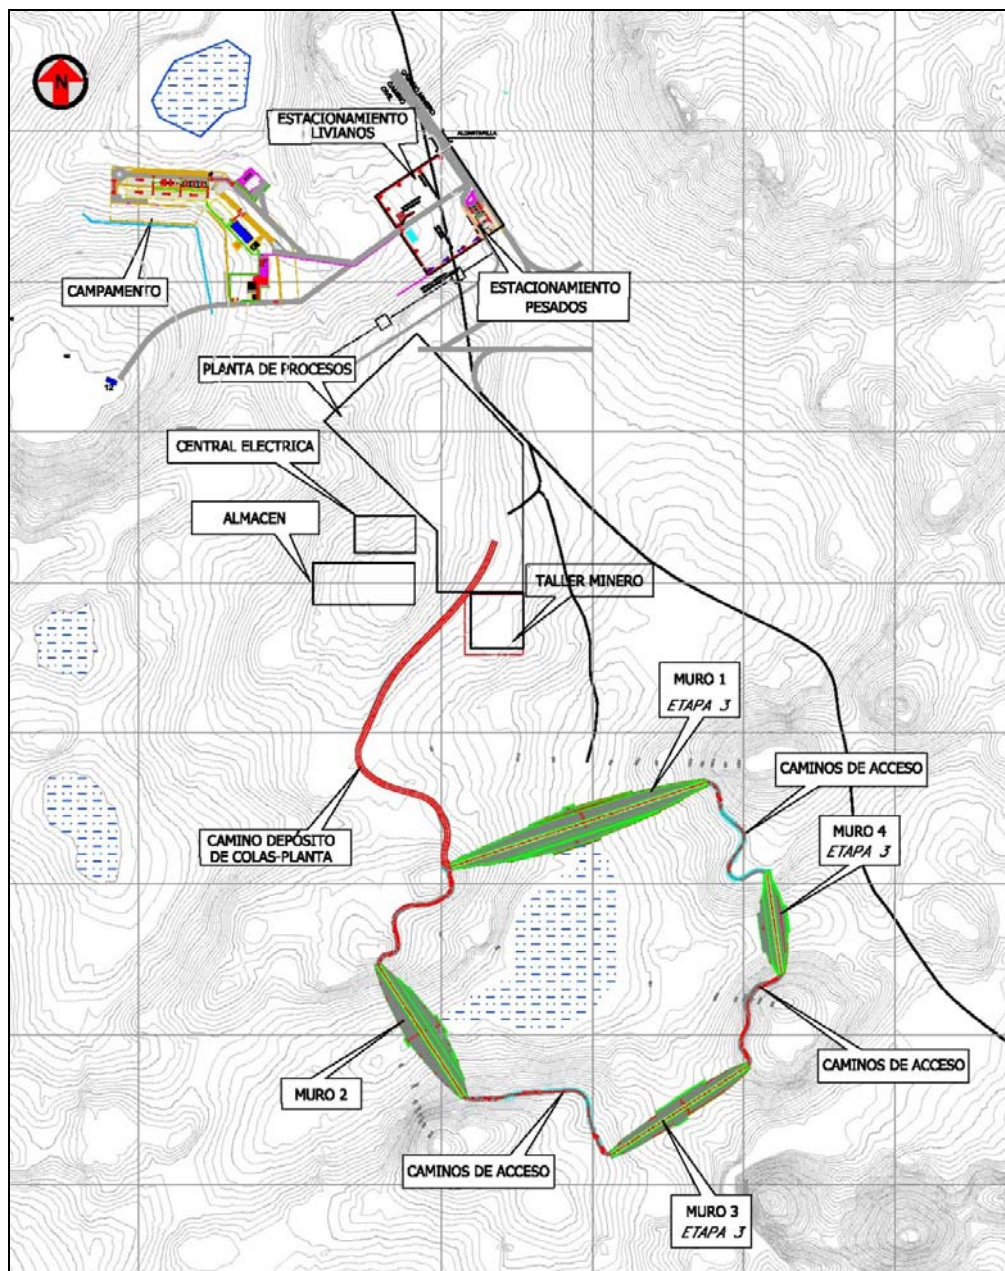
Vista en planta del dique de colas y de las principales instalaciones del Sector Martinetas.
